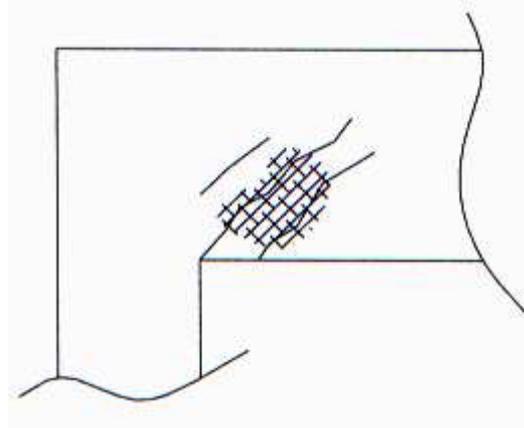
Fissuras por cortante – esmagamento e tração do concreto simultaneamente
